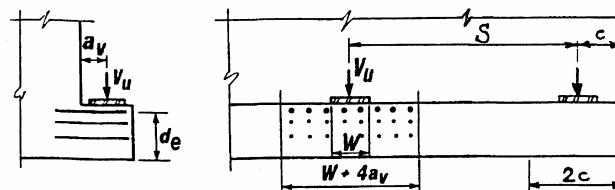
Ký hiệu và các vị trí có khả năng bị nứt đồi với gờ dầm khác
